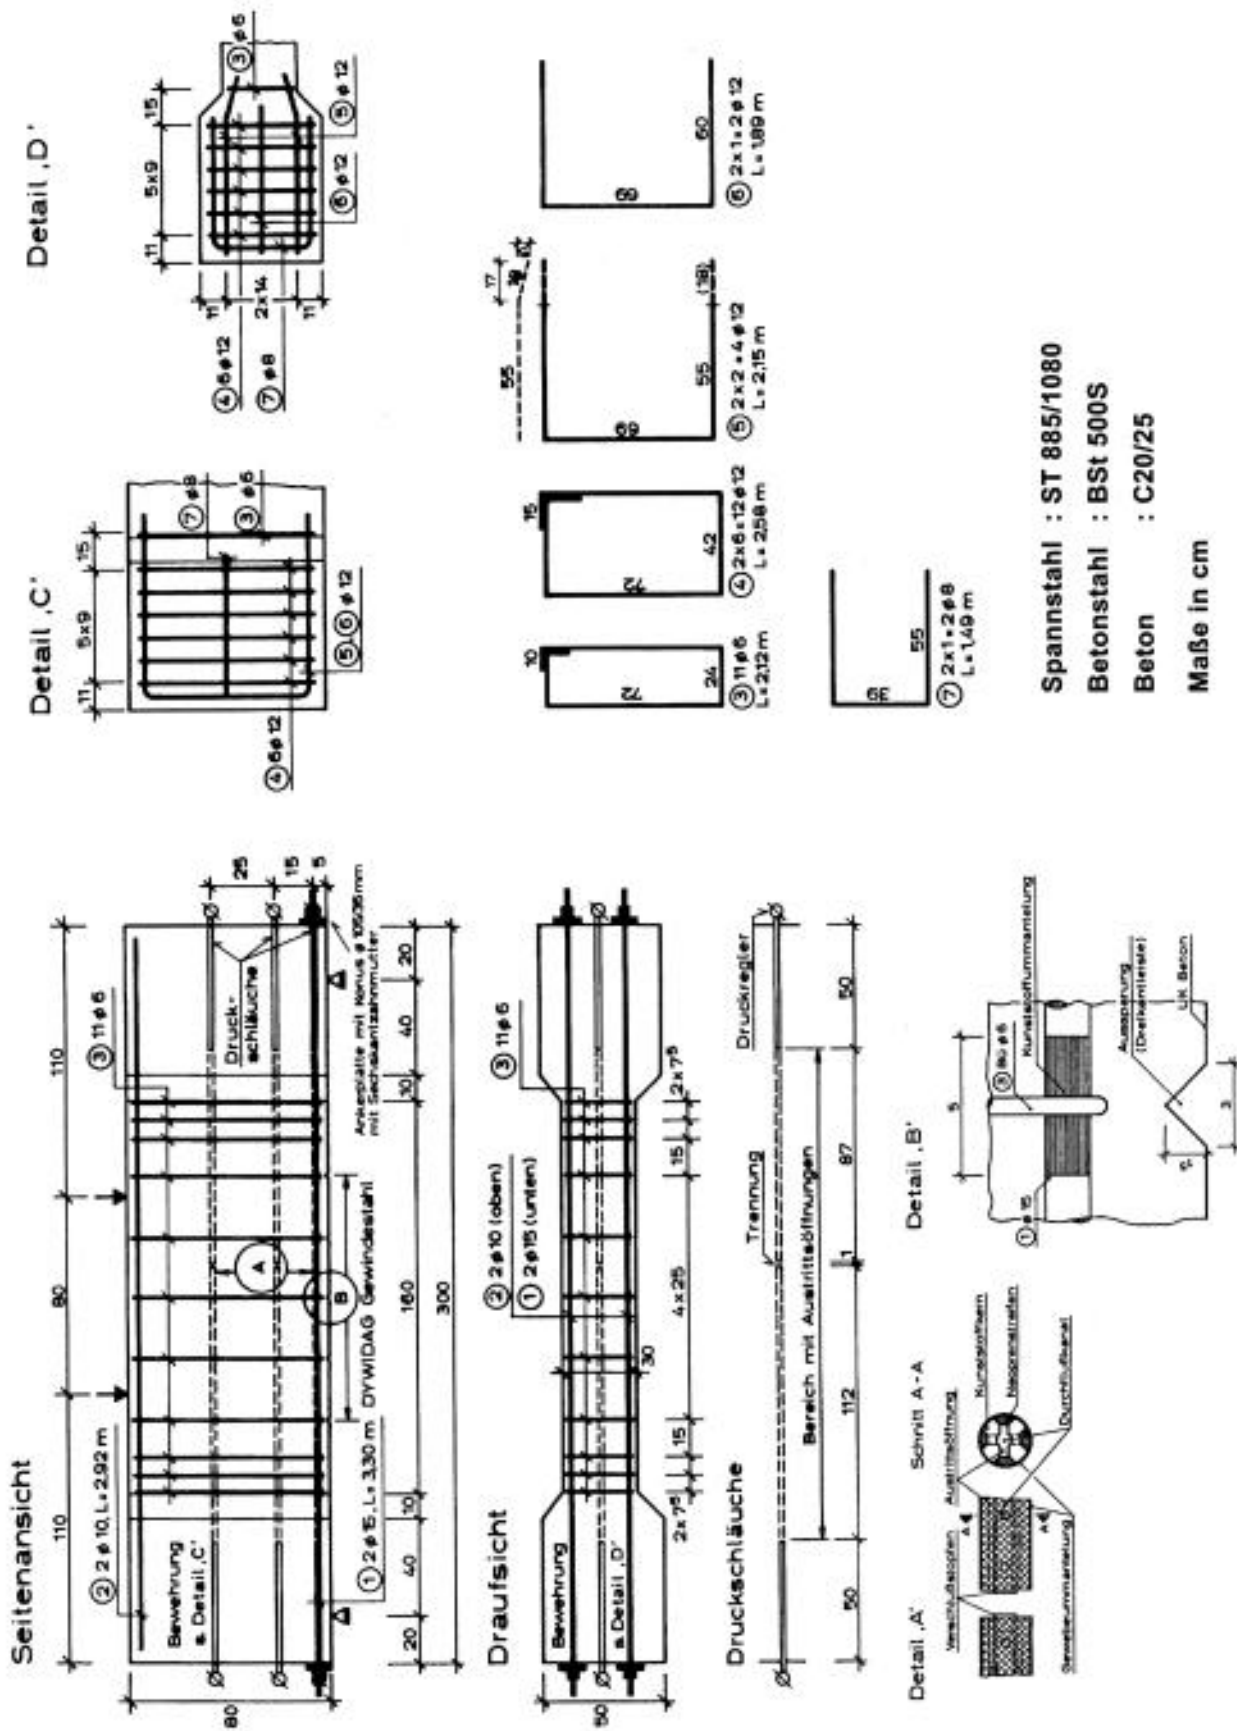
Schal- und Bewehrungsplan – Balken 1 und 2
